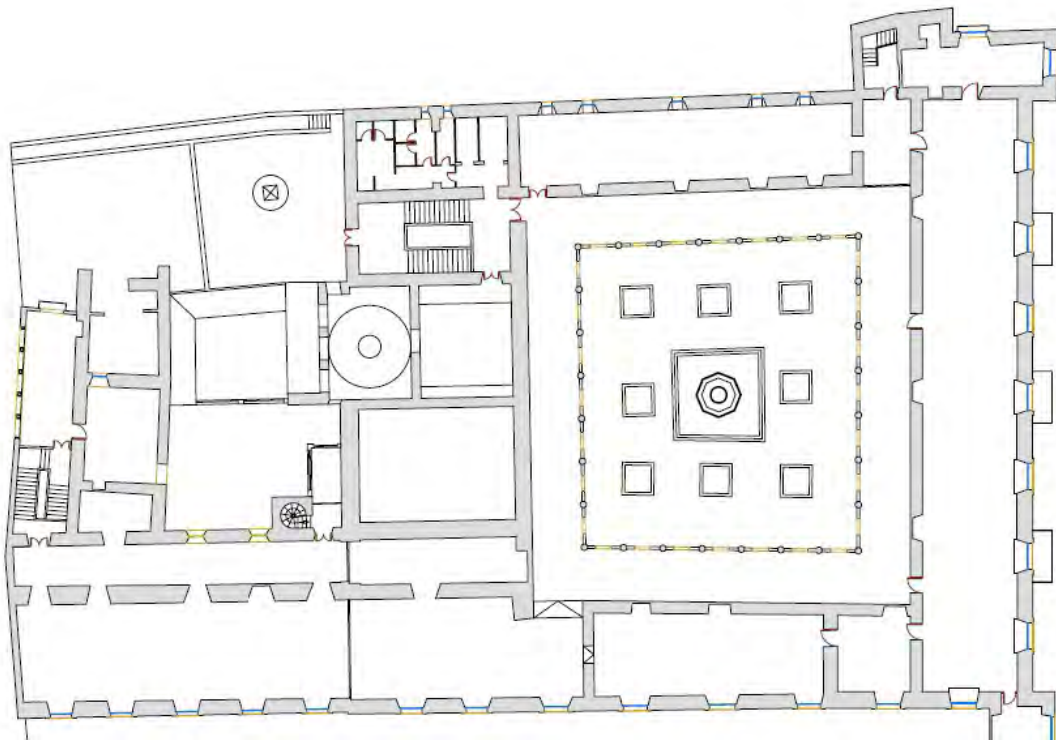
Estado previo. Planta segunda. (OAFJ, fragmento del plano A03).
